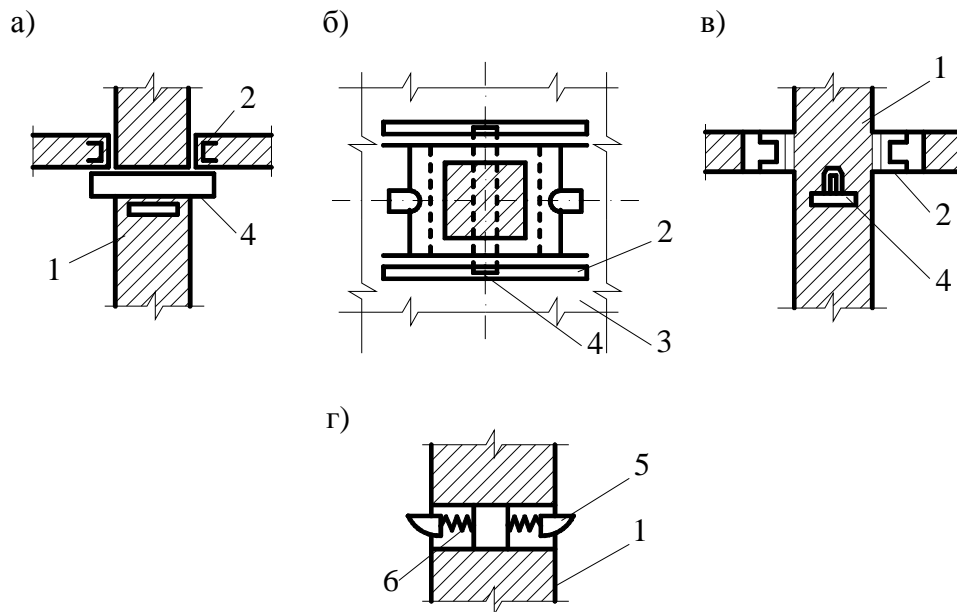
Вузол кріплення плит перекриття на колоні:
